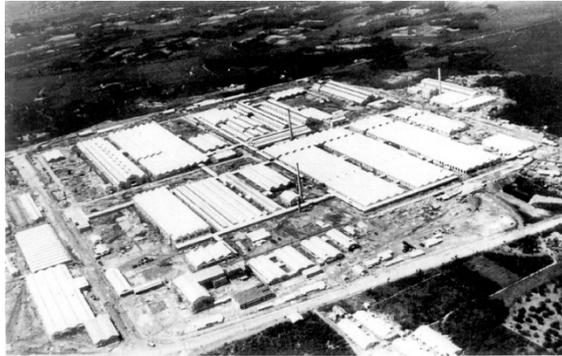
Planta de Koromo finalizando su construcción.¹⁶
